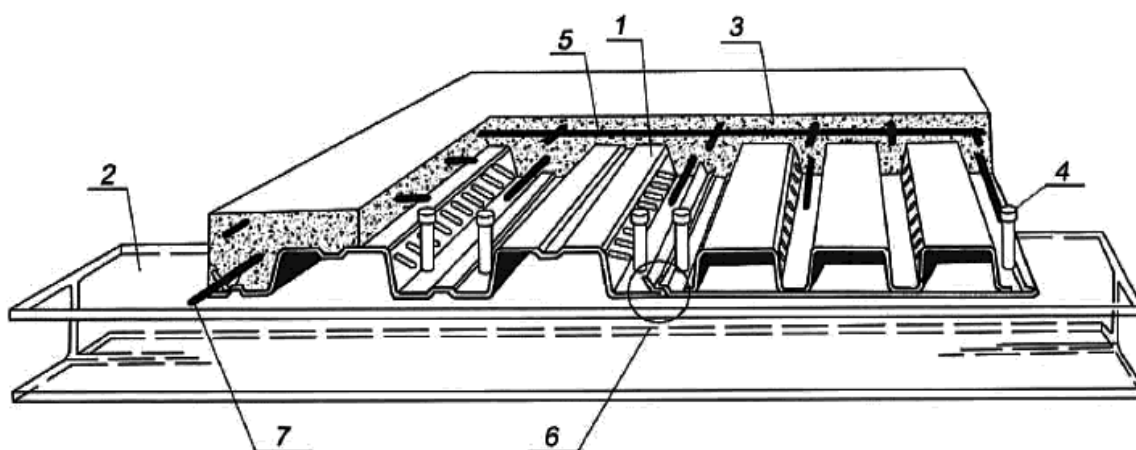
Конструкция сталежелезобетонной плиты, армированная профилированным настилом.
